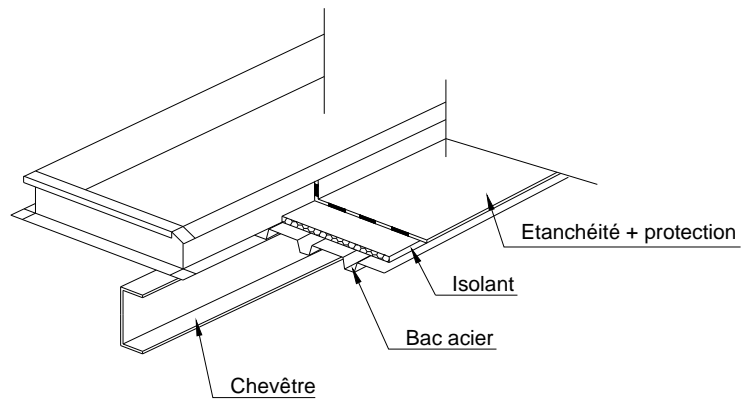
Raccordement des costières sur toitures terrasses et couvertures en bac acier
